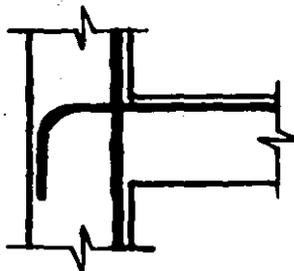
Anclaje de barras longitudinales de las vigas en columnas externas.
